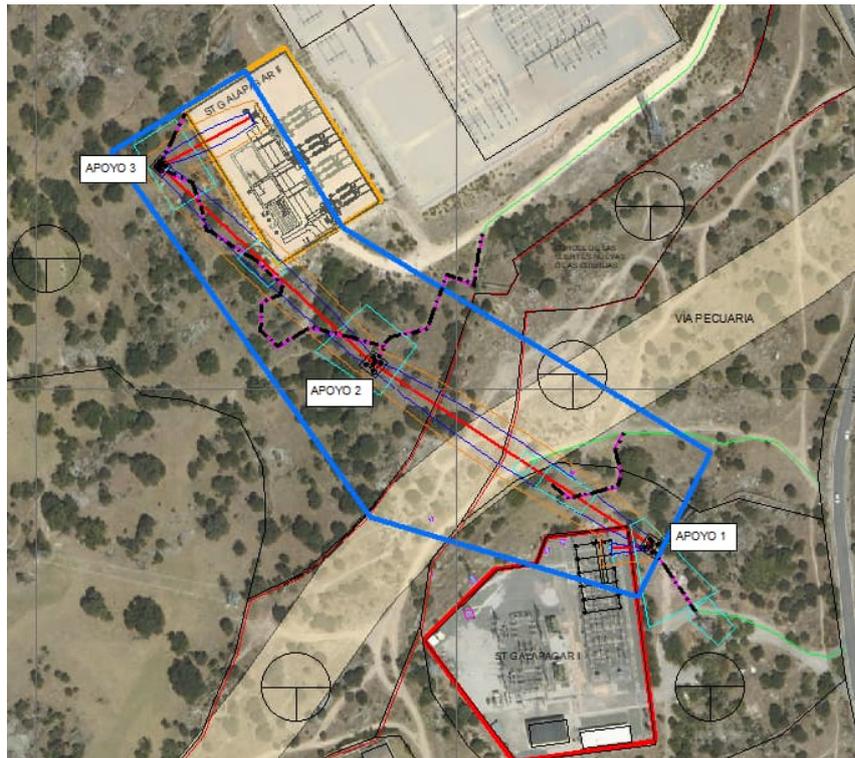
Proyecto Alternativa 1 Línea Eléctrica
